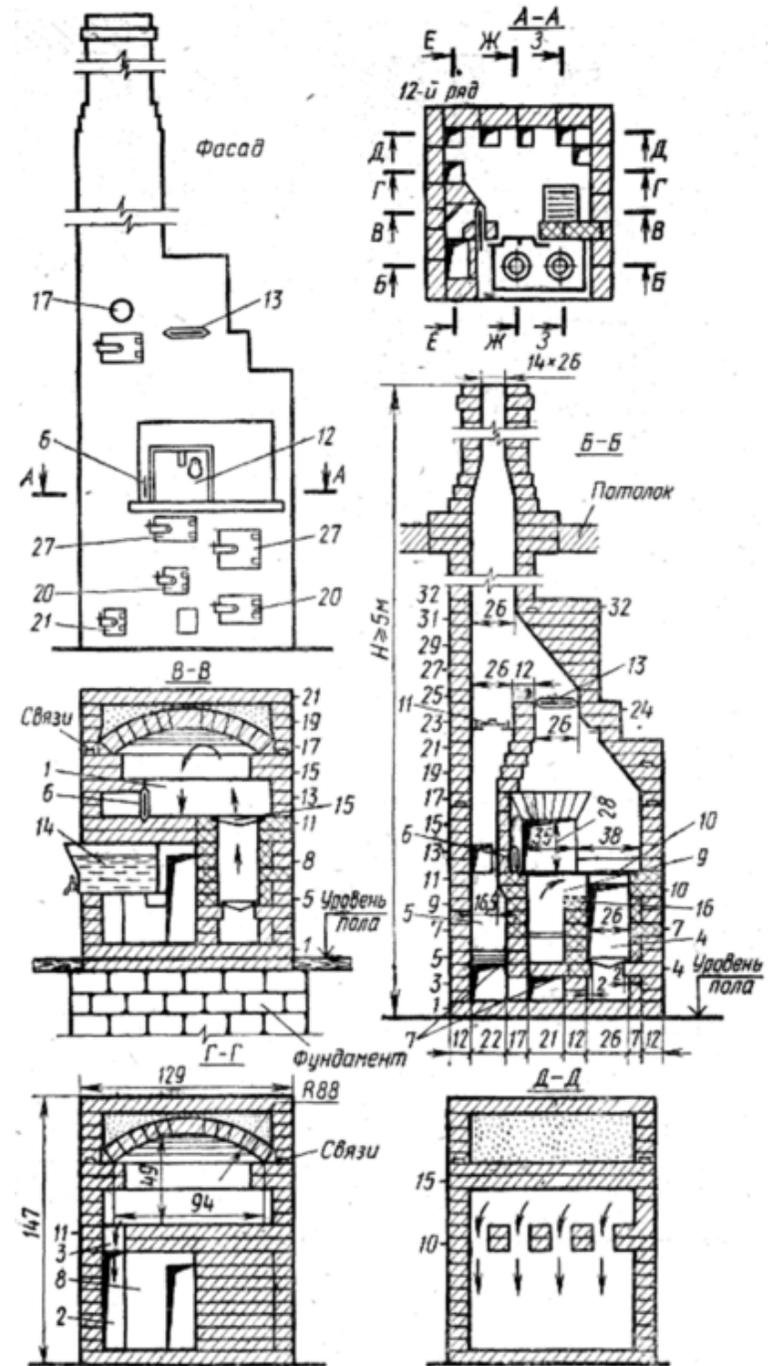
Разрезы русской печи «Теплушка-15» размером 129×129 см. (Размеры в см)
